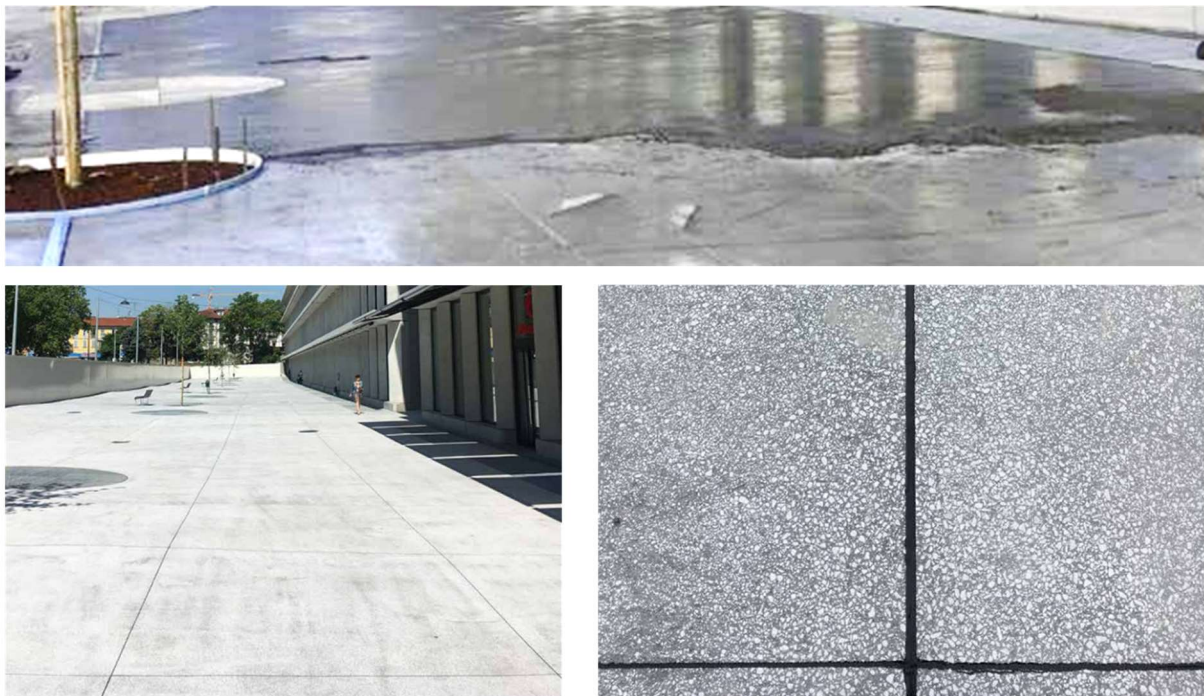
Realizzazione della pavimentazione esterna presso la Fondazione Feltrinelli a Milano. In alto la fase applicativa. In basso a sinistra una vista generale della pavimentazione finita mentre a destra un particolare della sua superficie (e dei giunti) dopo la levigatura finale utilizzata per esaltare gli aggregati “bianco Carrara” utilizzati ad integrazione della tecnologia STRUCTURE PAV.
